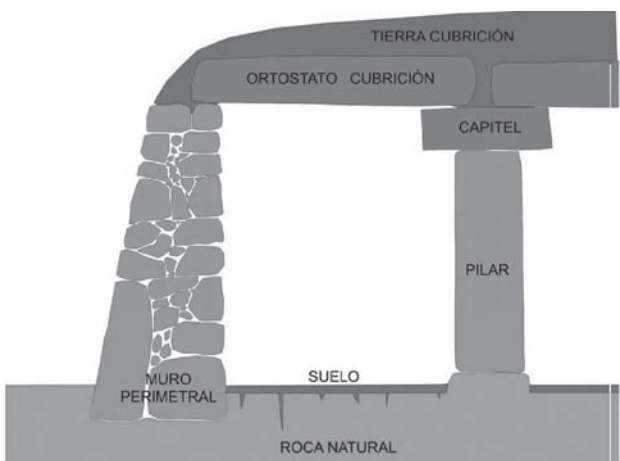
Reconstrucción hipotética de la vivienda talayótica, en la parte oeste, construida totalmente exenta. Sobre los muros de piedra podría haberse levantado una cubierta de piedra o vegetal y, sobre ella, un recubrimiento arcilloso para hacerlo impermeable. Dibujo de Fco. J. López Fraile.
